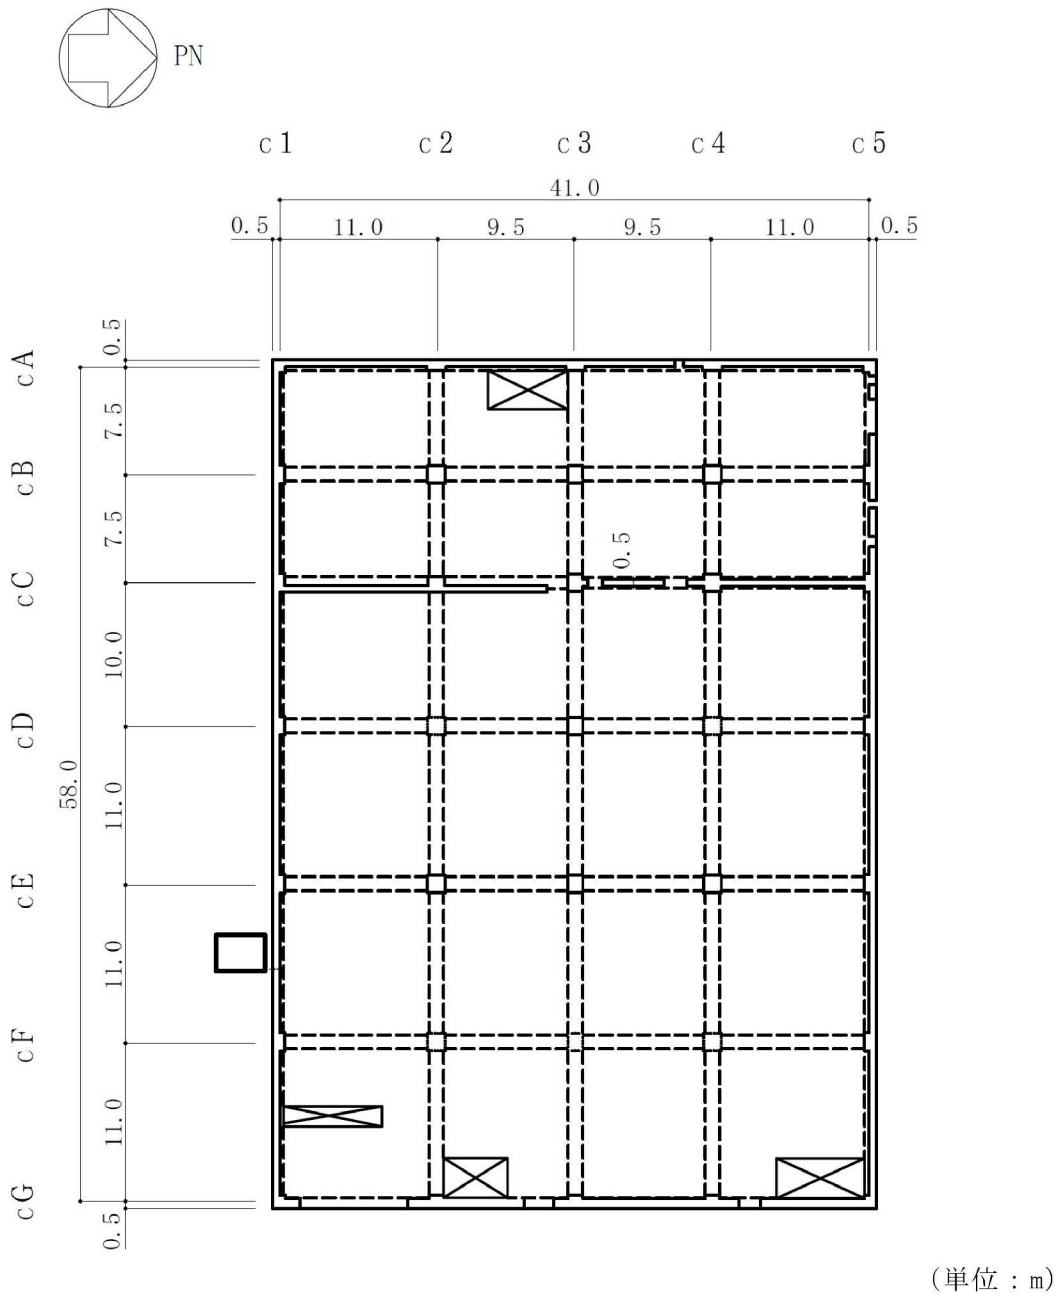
コントロール建屋の概略平面図 (2F, T.M.S.L. 17.3m) (4/5)
